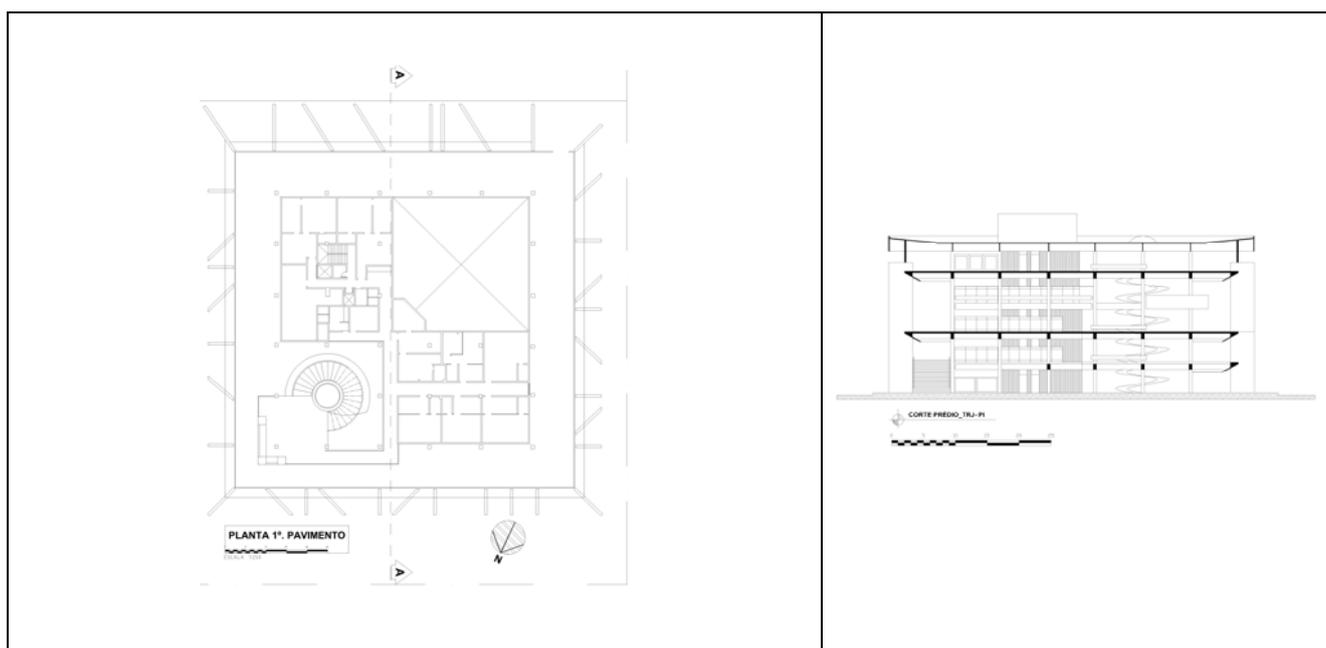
Planta baixa e corte esquemático do Tribunal de Justiça do Piauí
